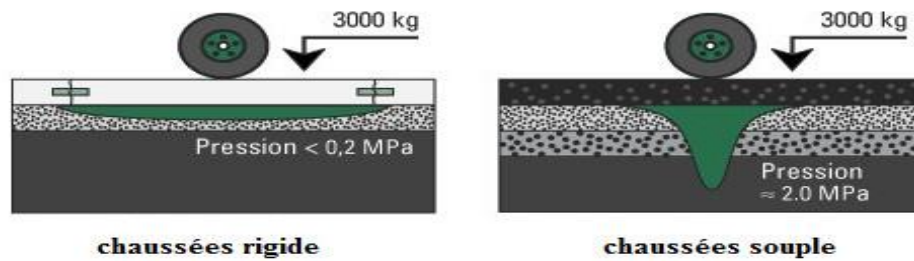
Répartition des charges sur la chaussée souple et la chaussée rigide.
